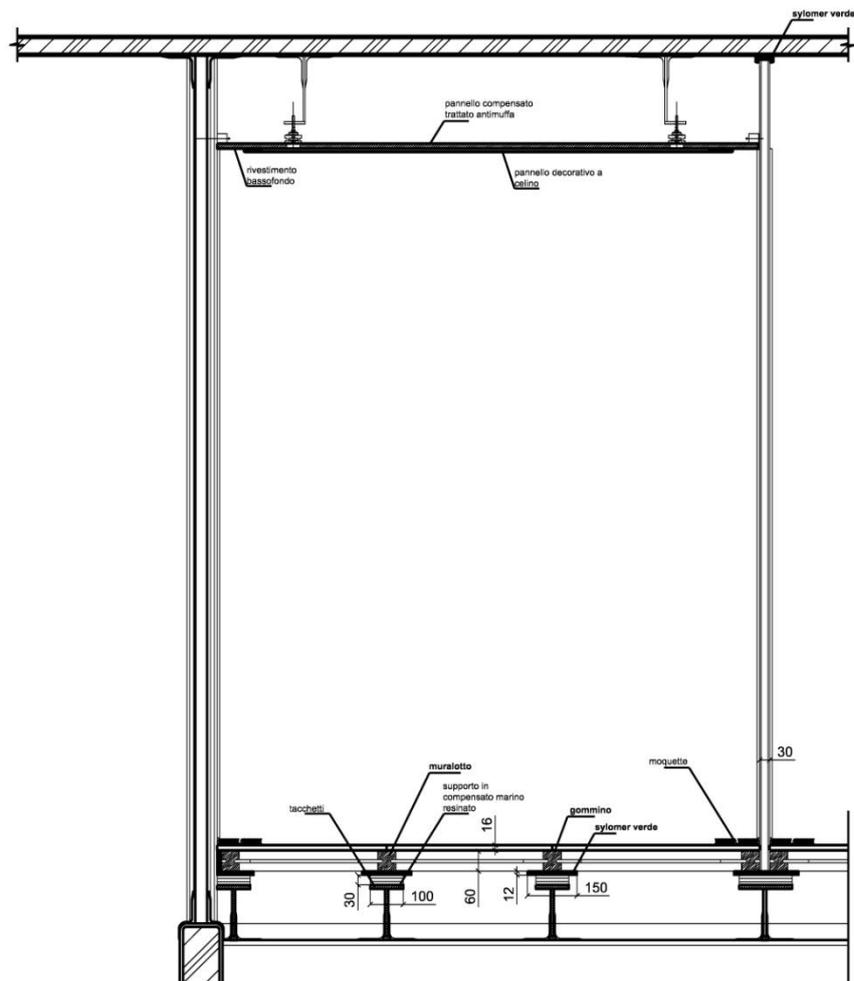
Sezione tipica che evidenzia la composizione del telaio del soffitto e del pavimento
